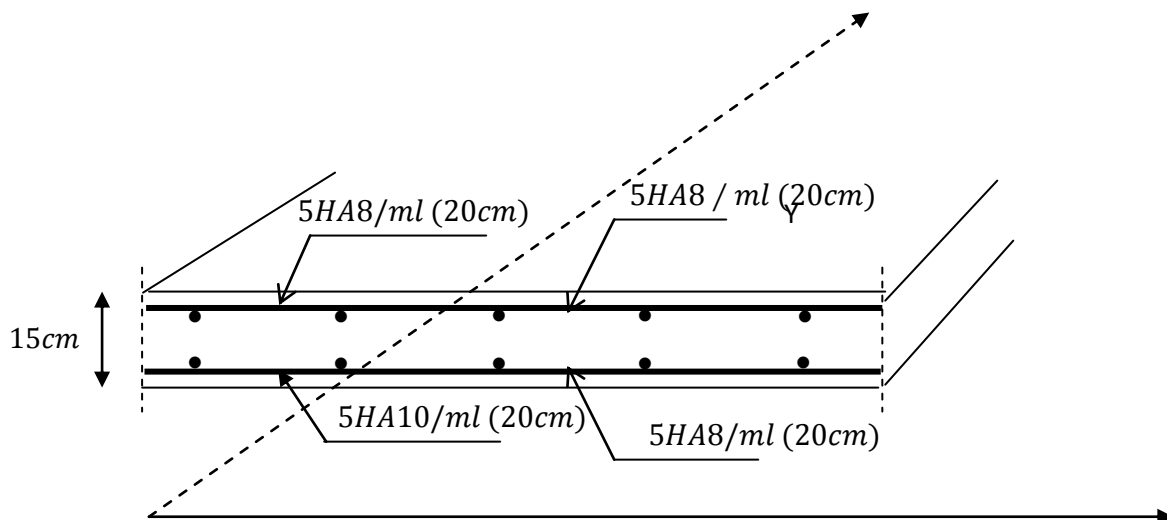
Ferrailage de la dalle pleine de la salle machine.
